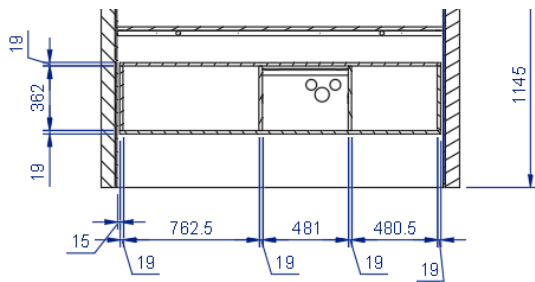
Pormenor do desenho técnico onde está localizado os esgotos. Fonte: Autora
